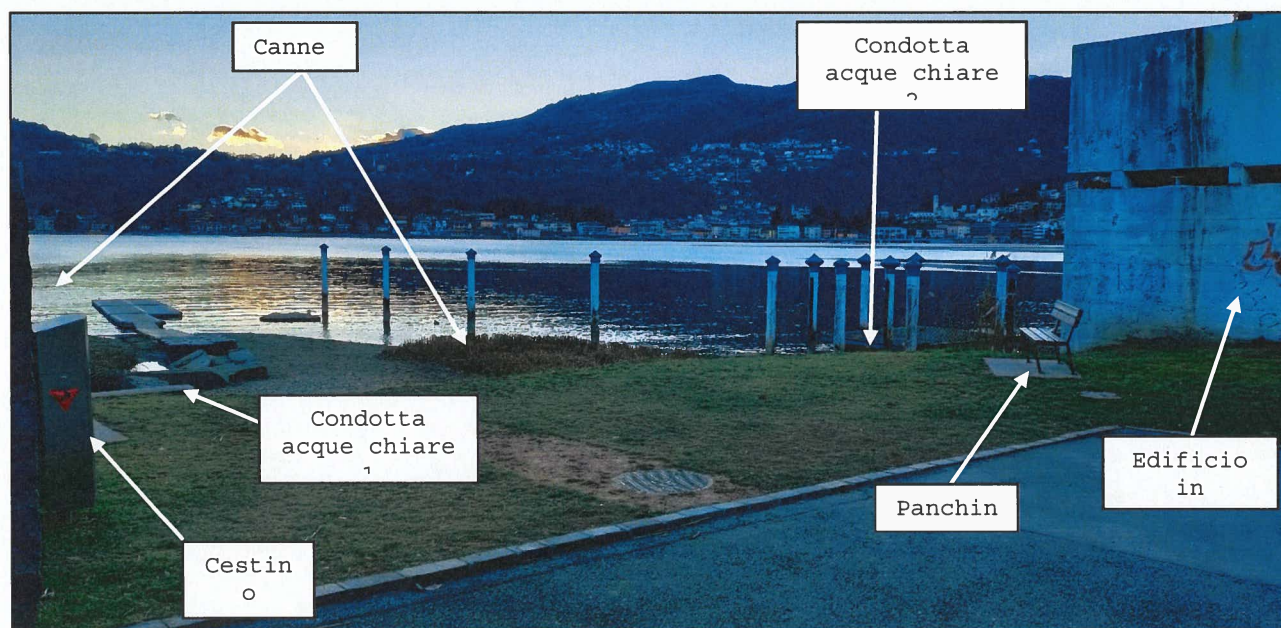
vista da Nord dell'area di progetto (stato marzo 2022).
